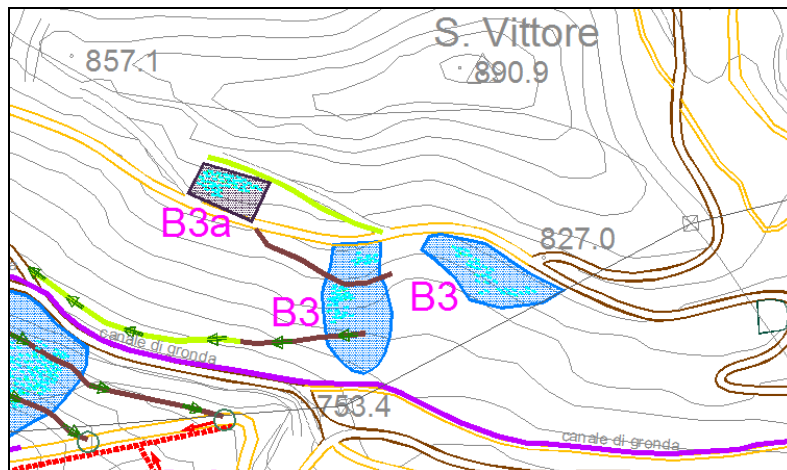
Unità progettuale B3 (cfr. elaborato C2 - Planimetria generale di progetto)
